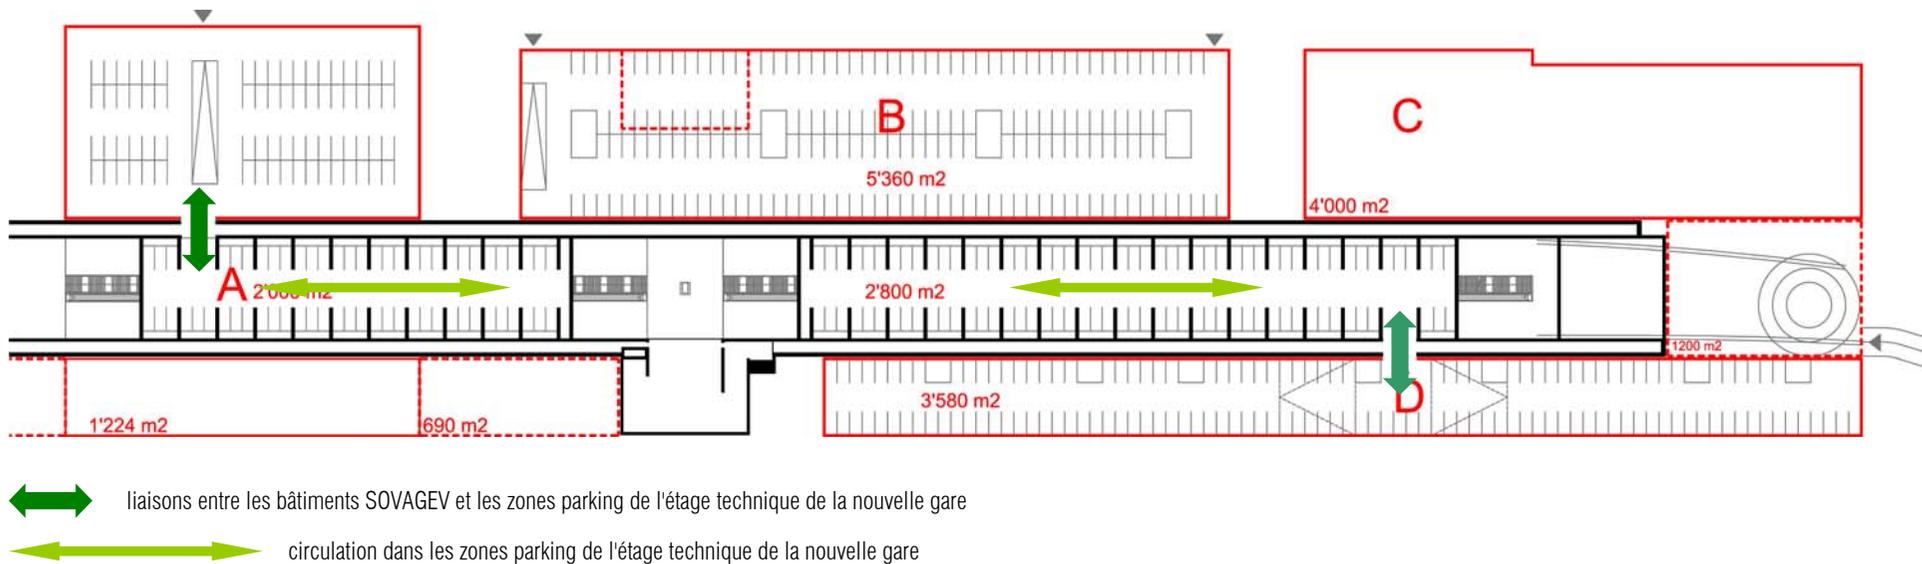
Vue en plan du 2^{ème} sous-sol avec accès parking
